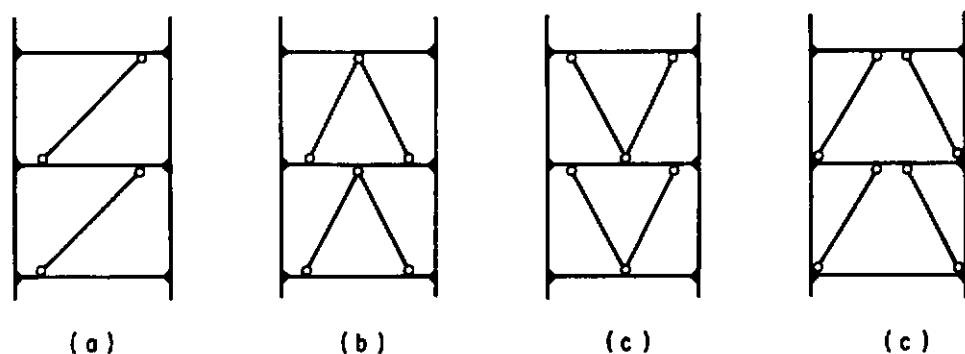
CONTRAVENTAMENTOS COM DIAGONAIS EXCÊNTRICAS.
